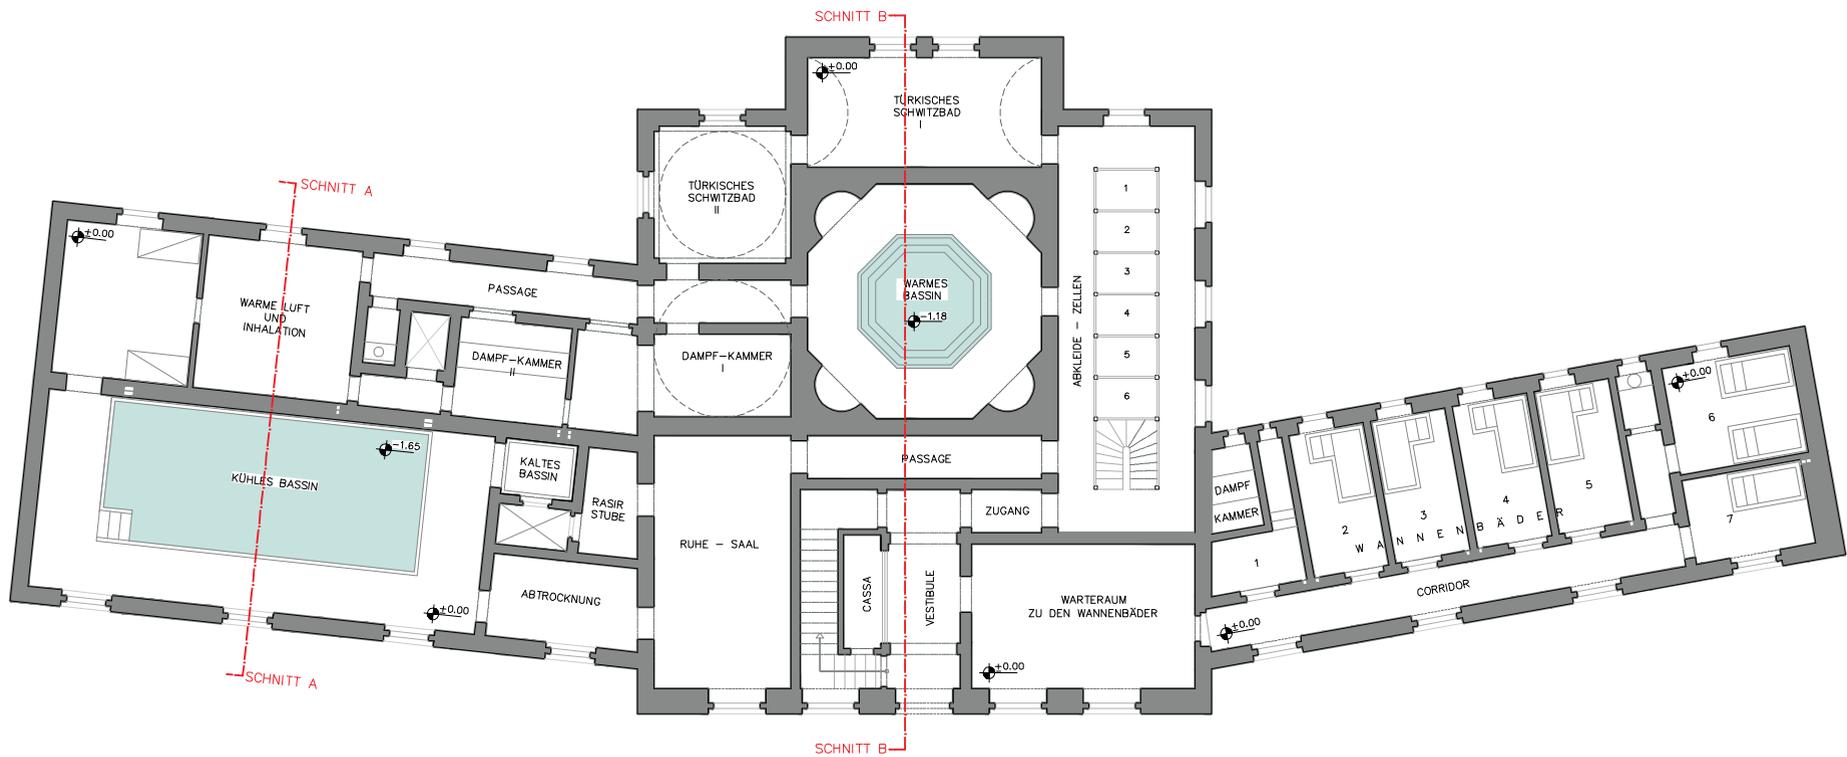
Grundriss des alten Gebäudes EG M 1:200
